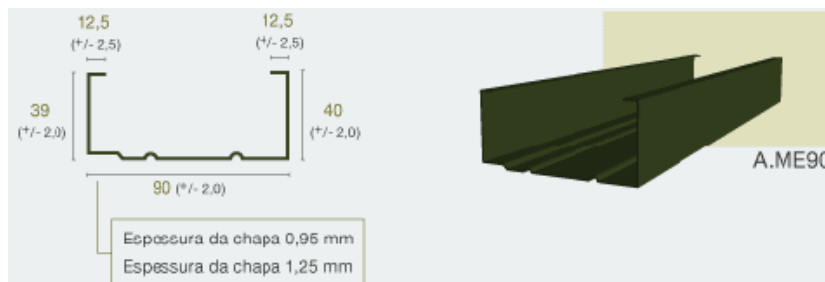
Exemplo de um tipo de perfil dobrado, *Montante estrutural de 90*, componente do sistema construtivo *Light Steel Frame*.
